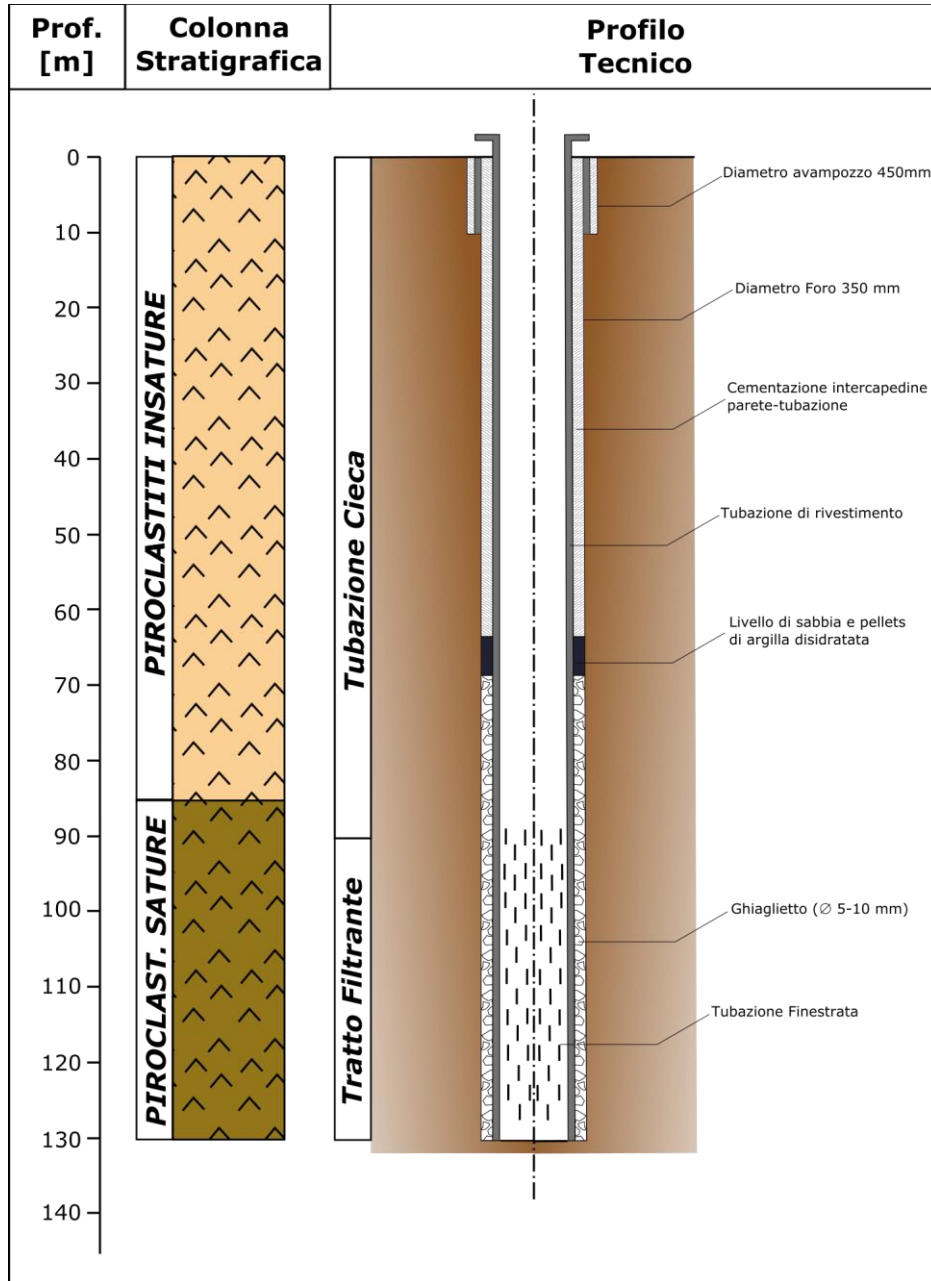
a Schema del Profilo Tecnico del Pozzo Tipo
